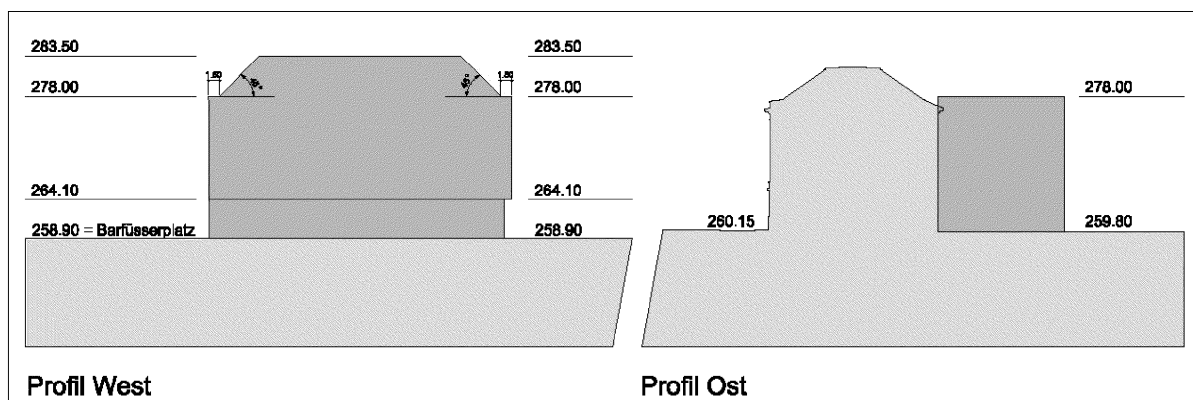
Plan Nr. 13'175. Bebauungsplan: Profile West und Ost. (kein Massstab)
